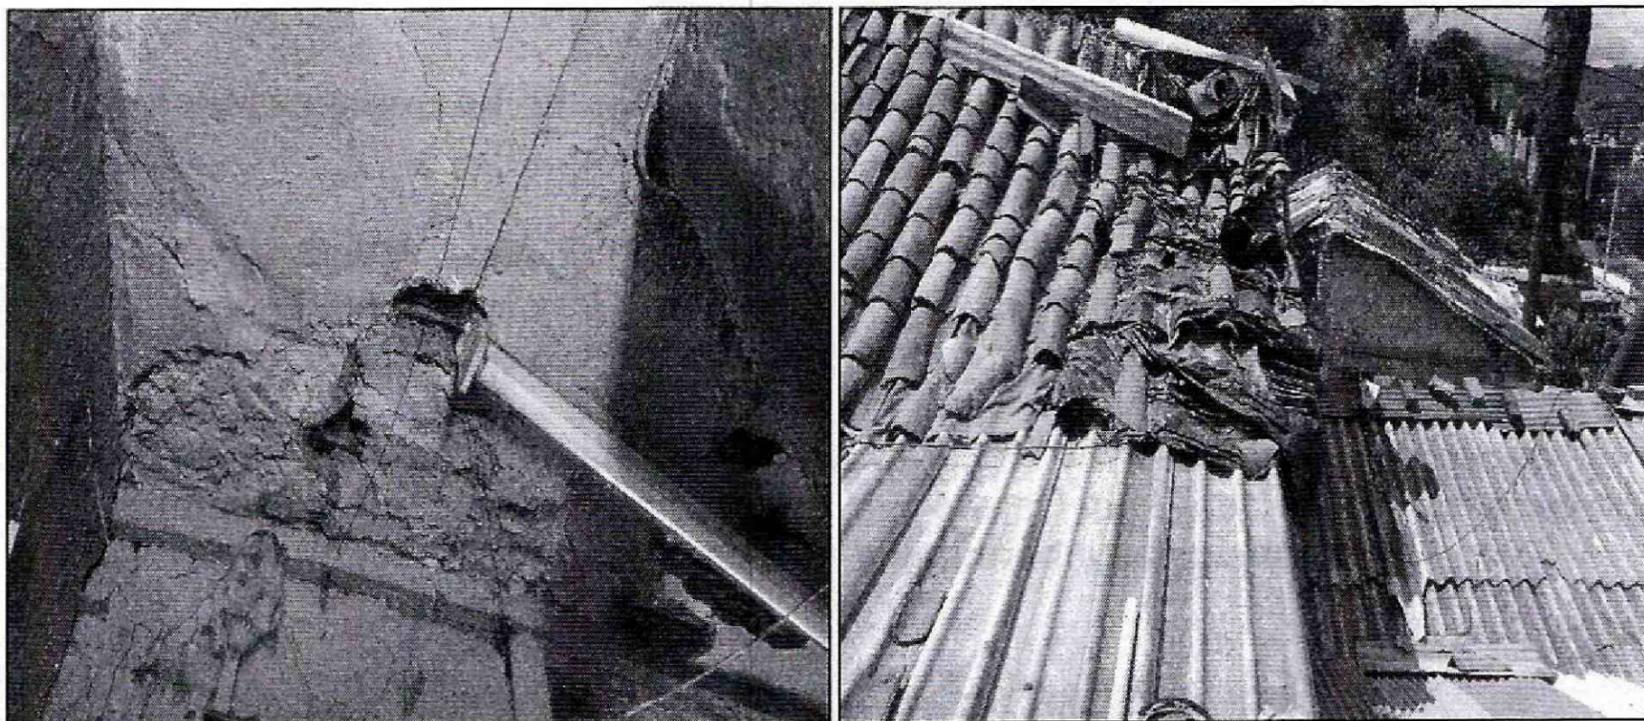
y 10. Vista de los desprendimientos en muro perimetral y de la deformación de la esterilla del muro cubierta de la vivienda de la Calle 4 Sur No. 5-48, en el Barrio Las Brisas, de la Localidad de San Cristóbal, así como de la capa de mortero para la estabilización del adobe
